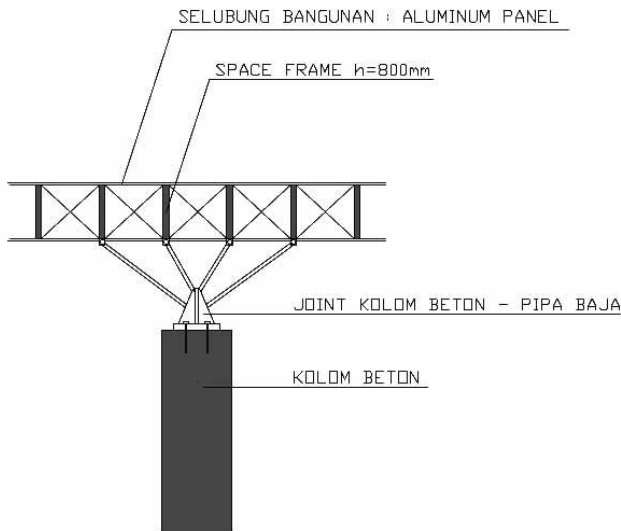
19. Kolom dan balok beton sebagai sistem struktur.
